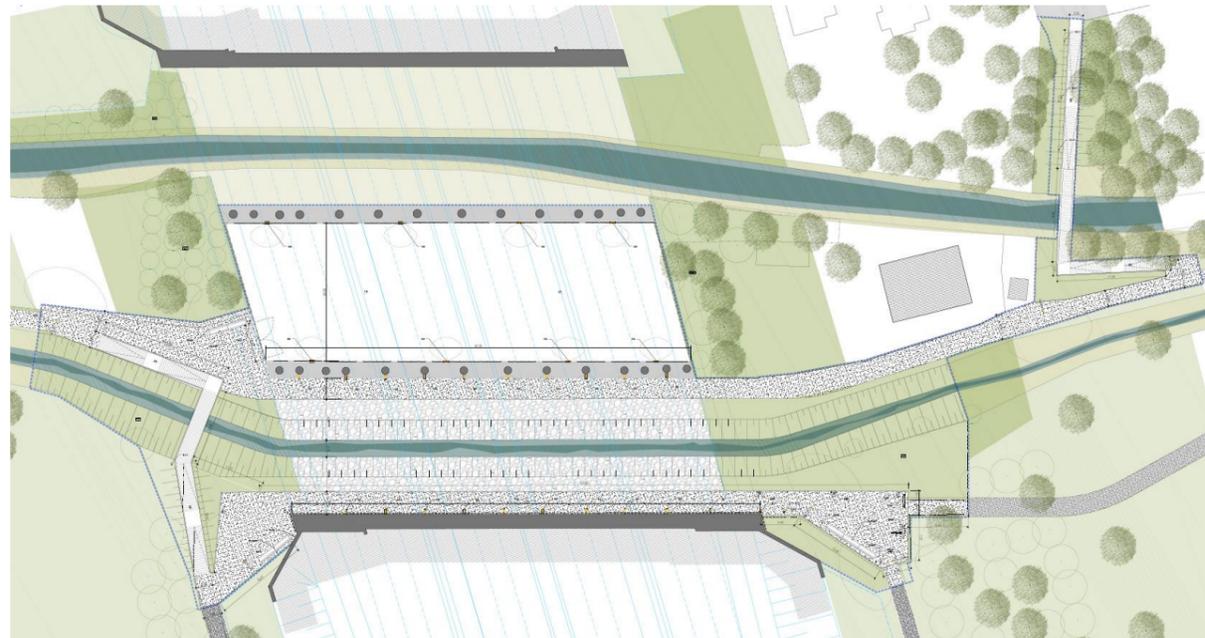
Planimetria con passerelle su Navile e Battiferro²⁹
